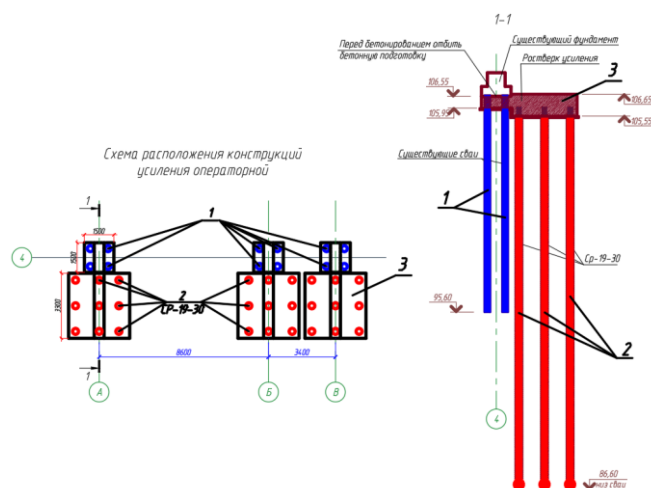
Схема усиления основания фундаментов операторной: 1 – существующие забивные сваи; 2 – буринъекционные сваи ЭРТ; 3 –подводимая монолитная железобетонные консольные балки под существующие железобетонные ростверки.
